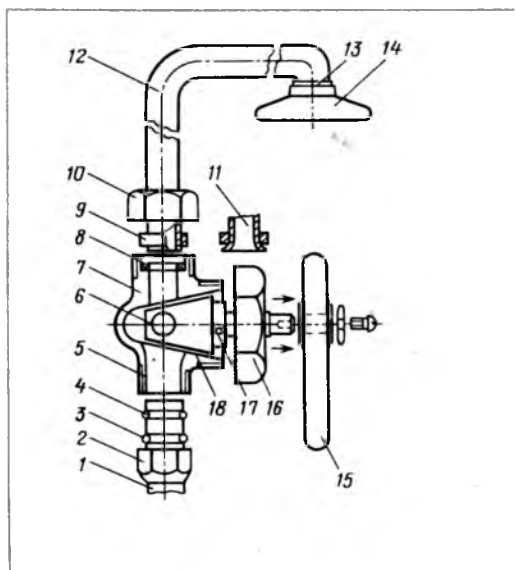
Смеситель пробкового типа в сборе: 1 — трубка; 2 — накидная гайка излива; 3 — разрезное пластмассовое кольцо; 4 — резиновое кольцо; 5 — нижний патрубок; 6 — конус подвижный; 7 — верхний патрубок; 8 — резиновая прокладка; 9 — кольцо резьбовое; 10 — накидная гайка; 11 — развальцовка трубки стационарной душевой сетки; 12 — трубка; 13 — прокладка; 14 — душевая сетка; 15 — рукоятка переключения смесителя; 16 — накидная регулировочная гайка; 17 — ограничитель; 18 — неподвижная коническая поверхность смесителя
